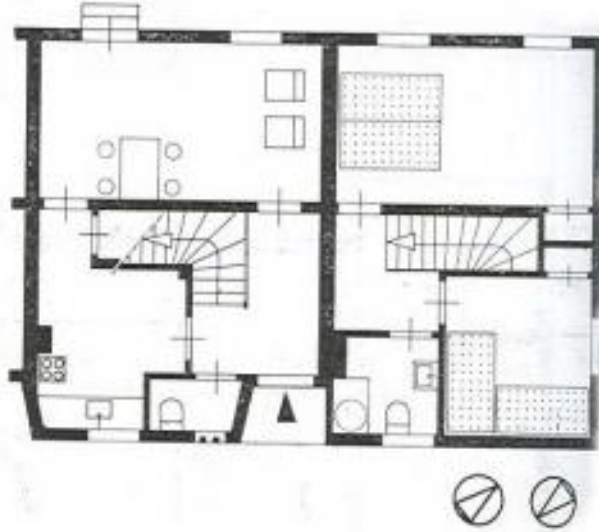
4. Levent Toplu Konutları A blok planı
